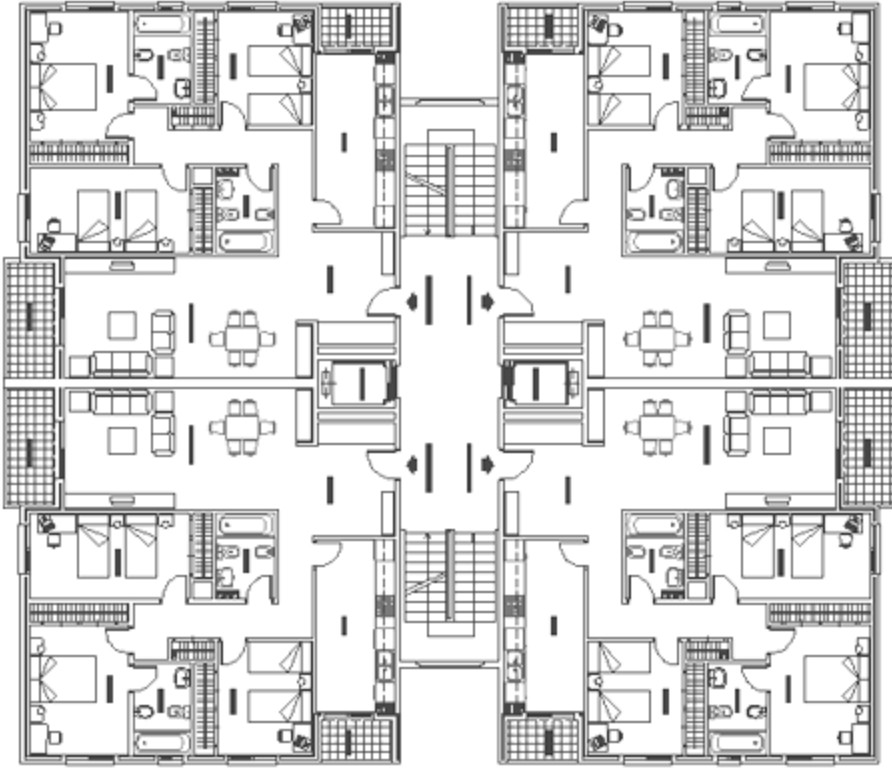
يوضح مسقط افقى لوحدات سكنية فى دور
